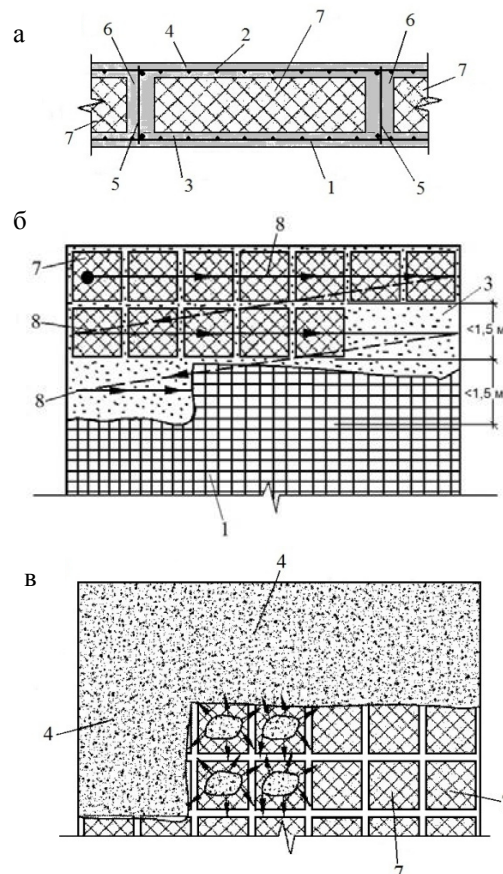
Способ устройства облегченного железобетонного перекрытия: а – поперечное сечение перекрытия; б и в – последовательность бетонирования перекрытия; 1, 2 – арматура нижней и верхней сеток; 3, 4 – нижняя и верхняя обшивка; 5 – арматурные каркасы; 6 – ребра перекрытия; 7 – вкладыши; 8 – направление бетонирования нижней обшивки перекрытия
